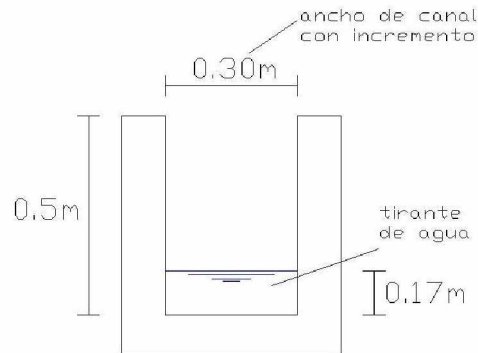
Sección del canal de rejillas para la Planta N°3
